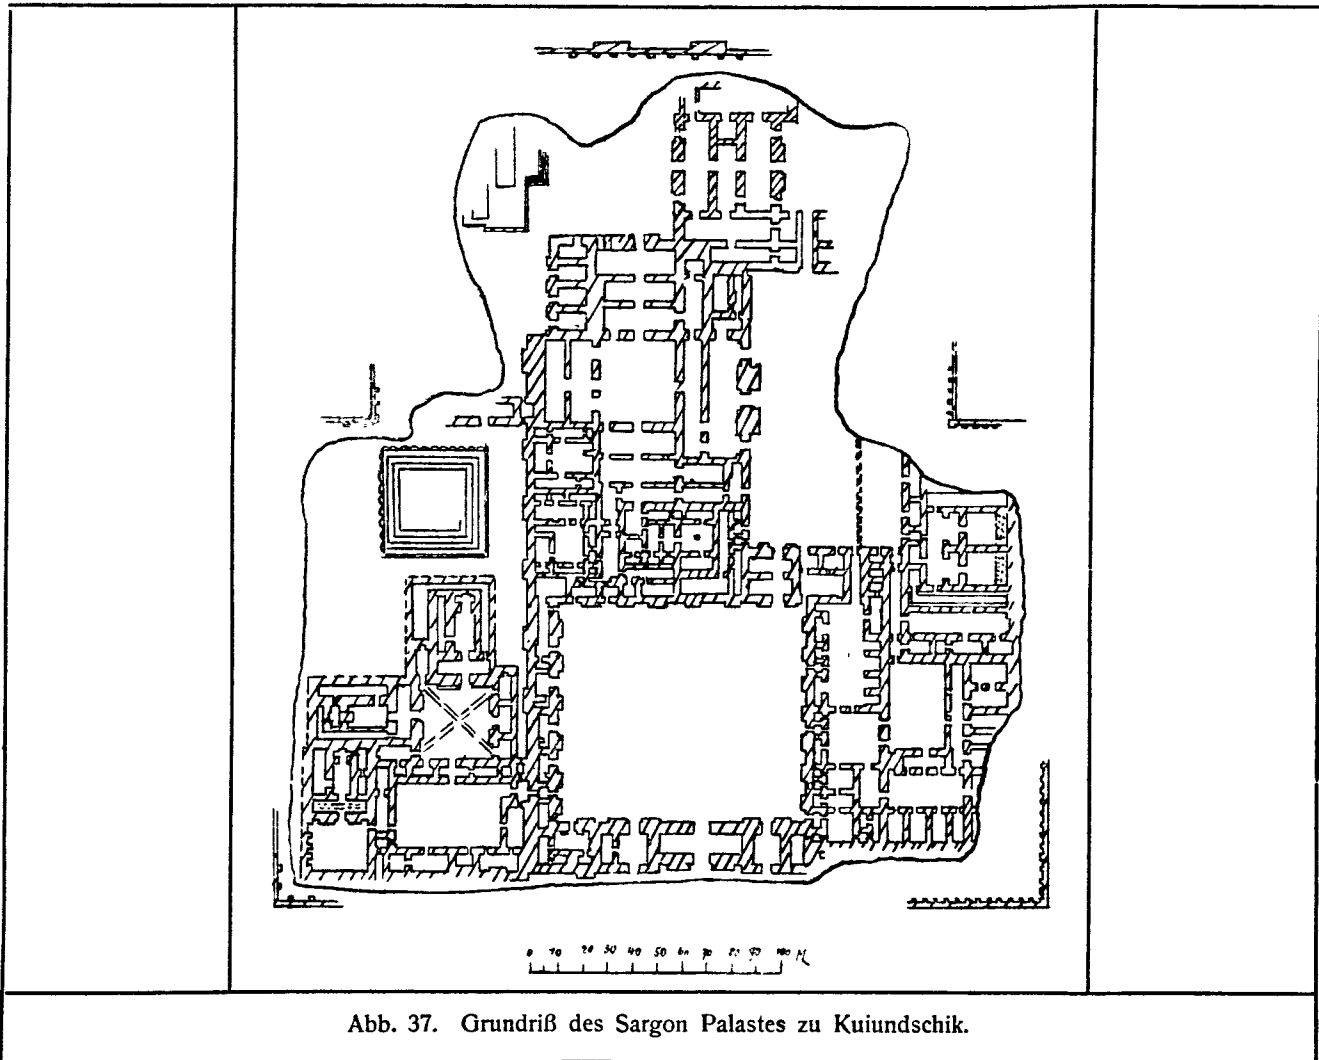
Grundriß des Sargon Palastes zu Kuiundschik.
